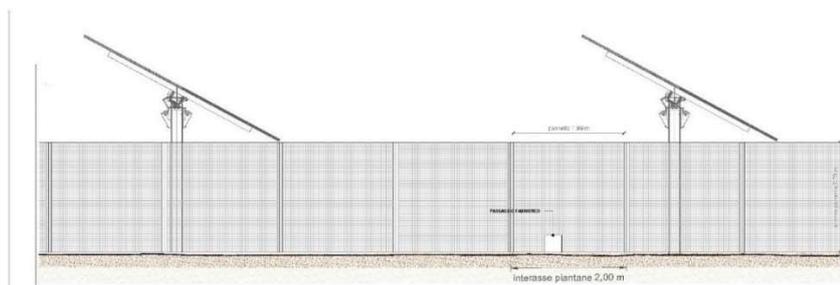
Prospetto recinzione perimetrale senza mitigazione
